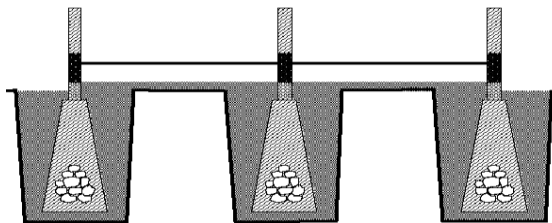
Bentuk Pondasi Pijler dengan tampak atas.
